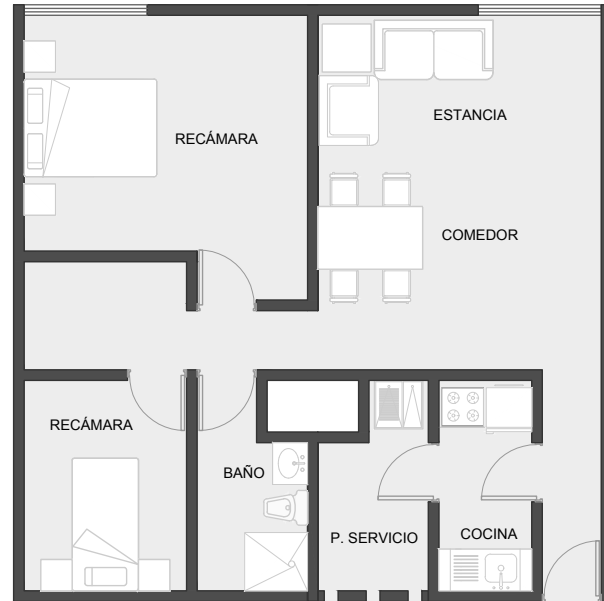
Planta arquitectónica original departamento tipo A-01 Fuente: Elaboración propia
